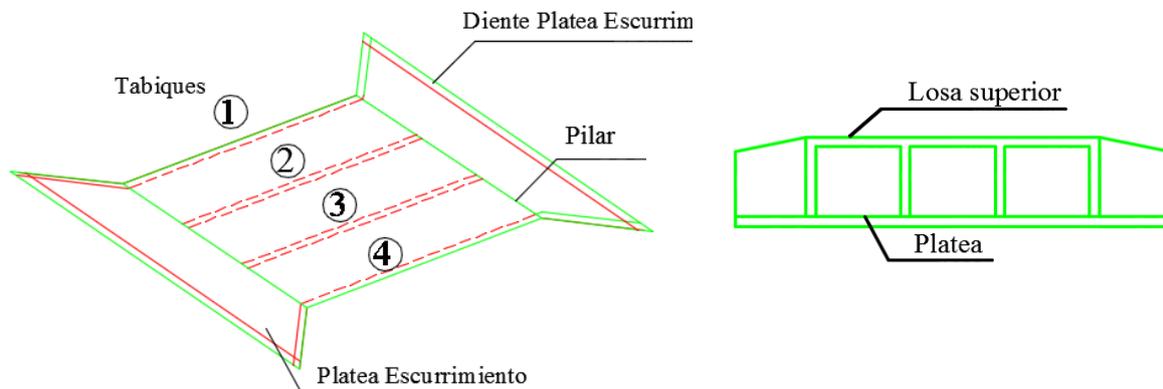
Elementos estructurales estudiados en Alcantarilla SE
